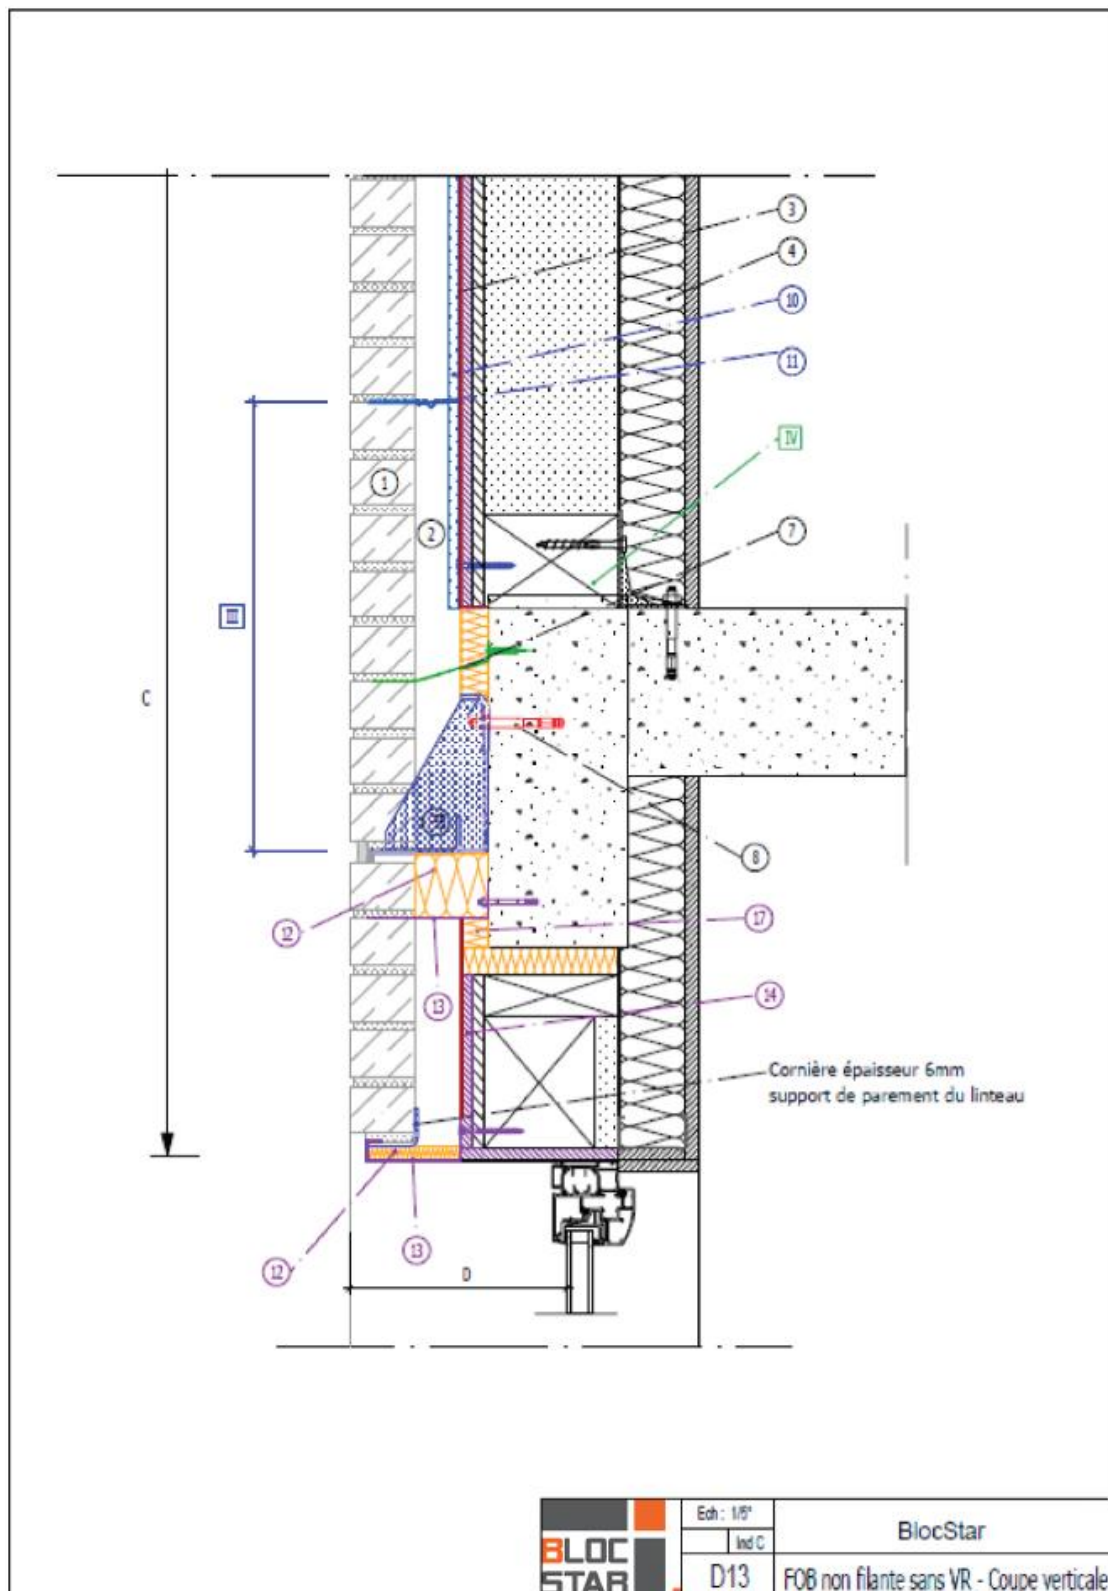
Traitement des embrasures – coupe verticale en linteau (FOB sans CVR)
